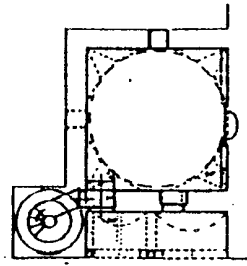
مسقط أفقى لمسجد صرغالى
